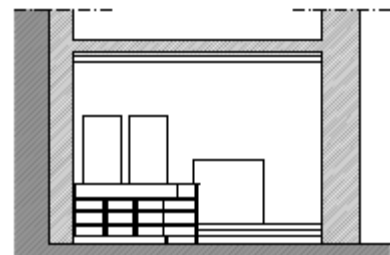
Corte DD – Esc. 1/200 – Autora do projeto
